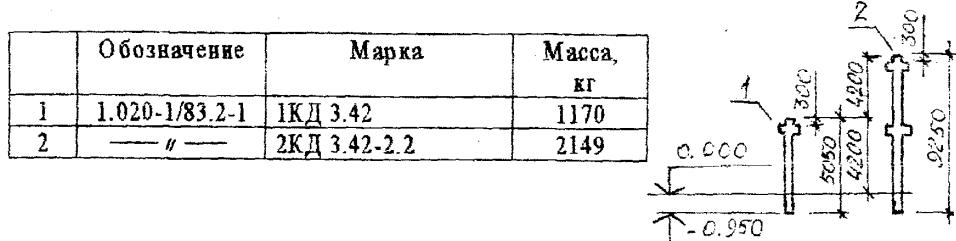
Колонны каркаса сечением 300х300 мм для зданий без подвала с высотой этажей 4200 мм
